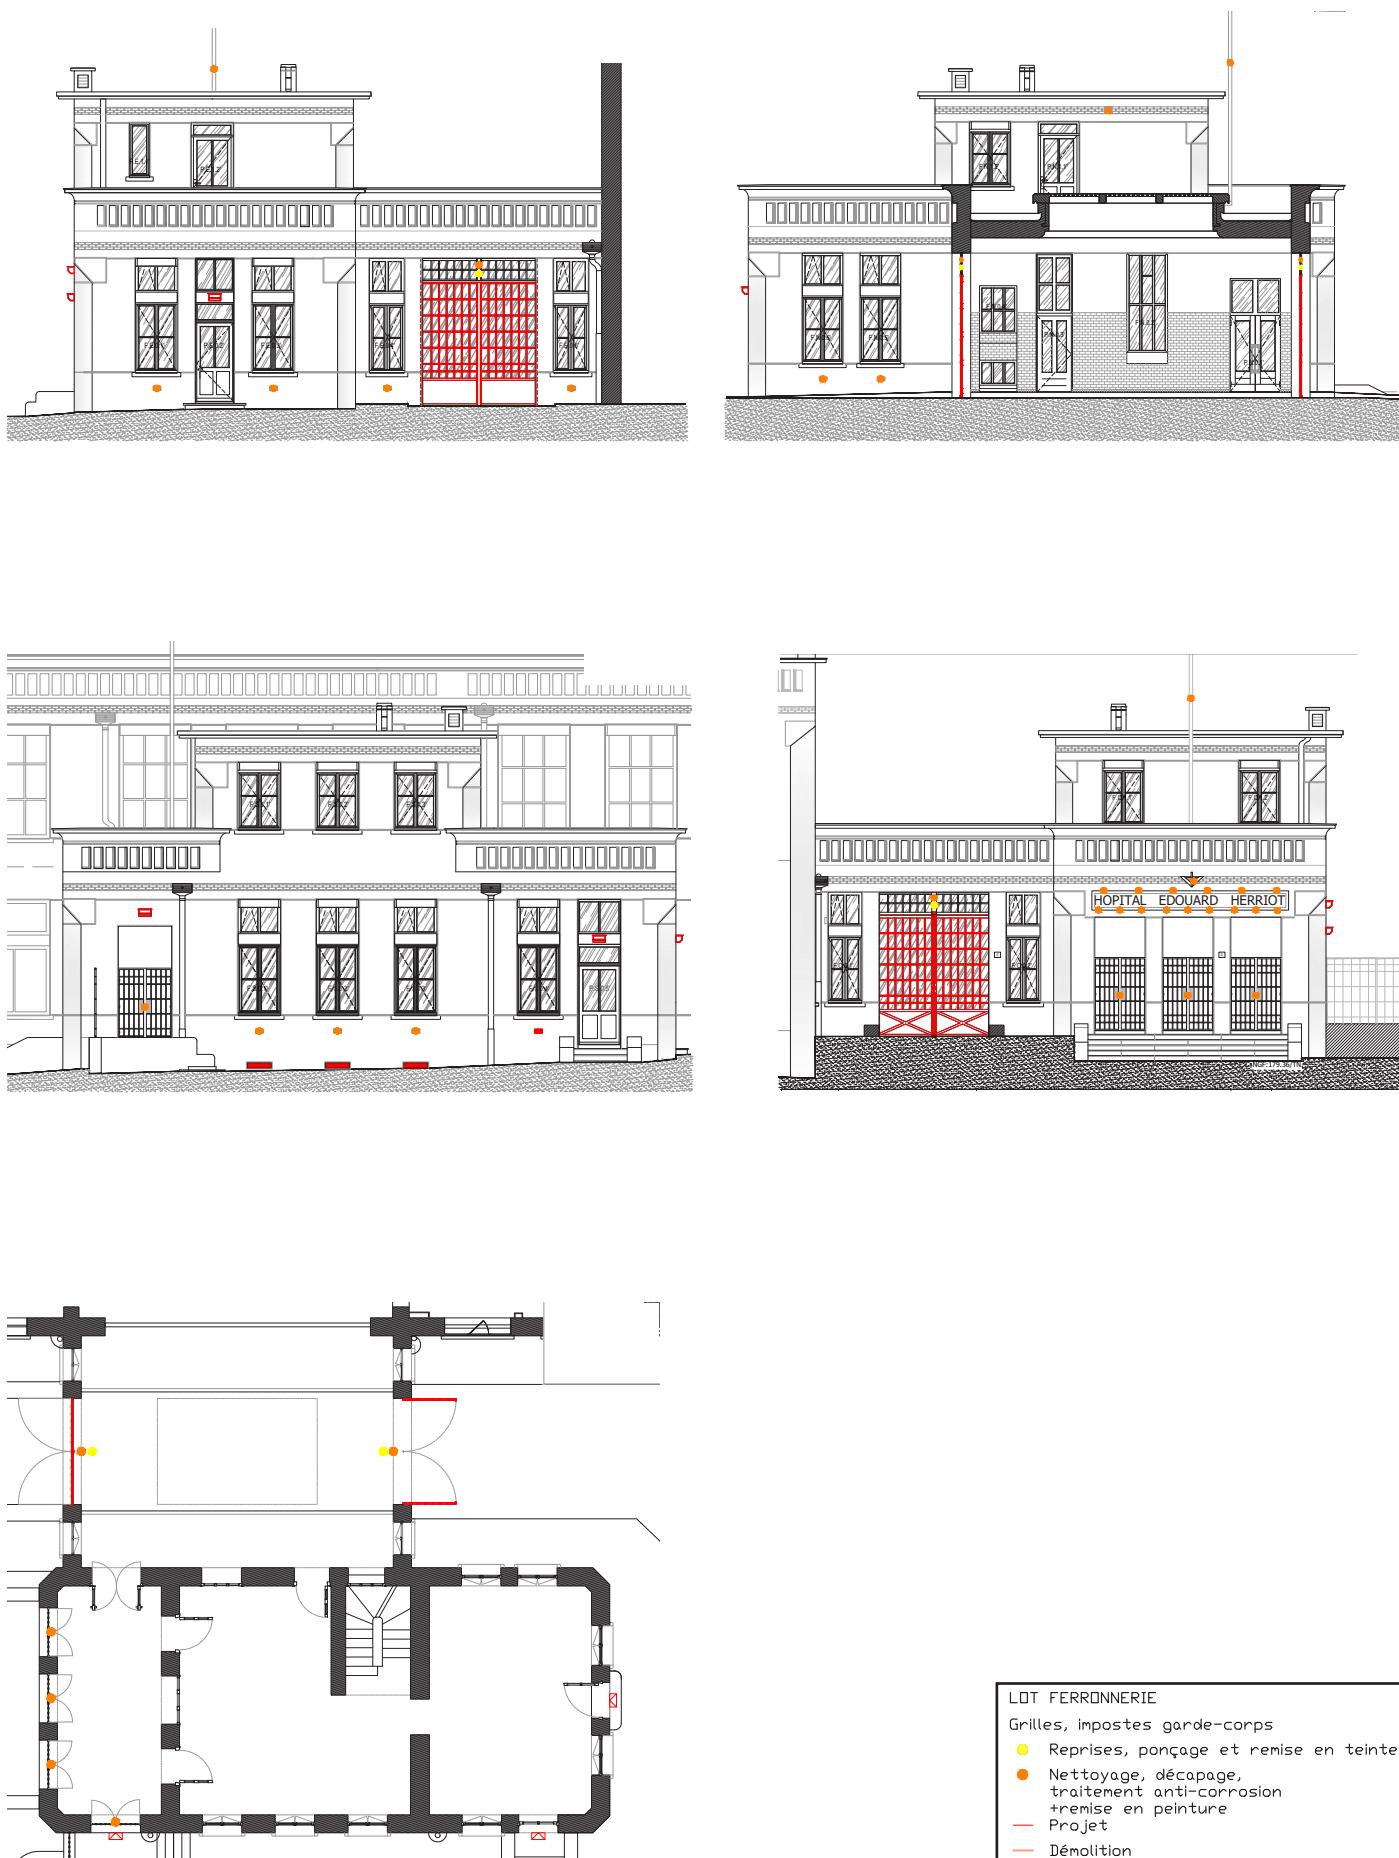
État projeté (APD) du lot Ferronneries, élévations, coupe-élévation et plans de niveaux, Agence Goutal, 2024.
